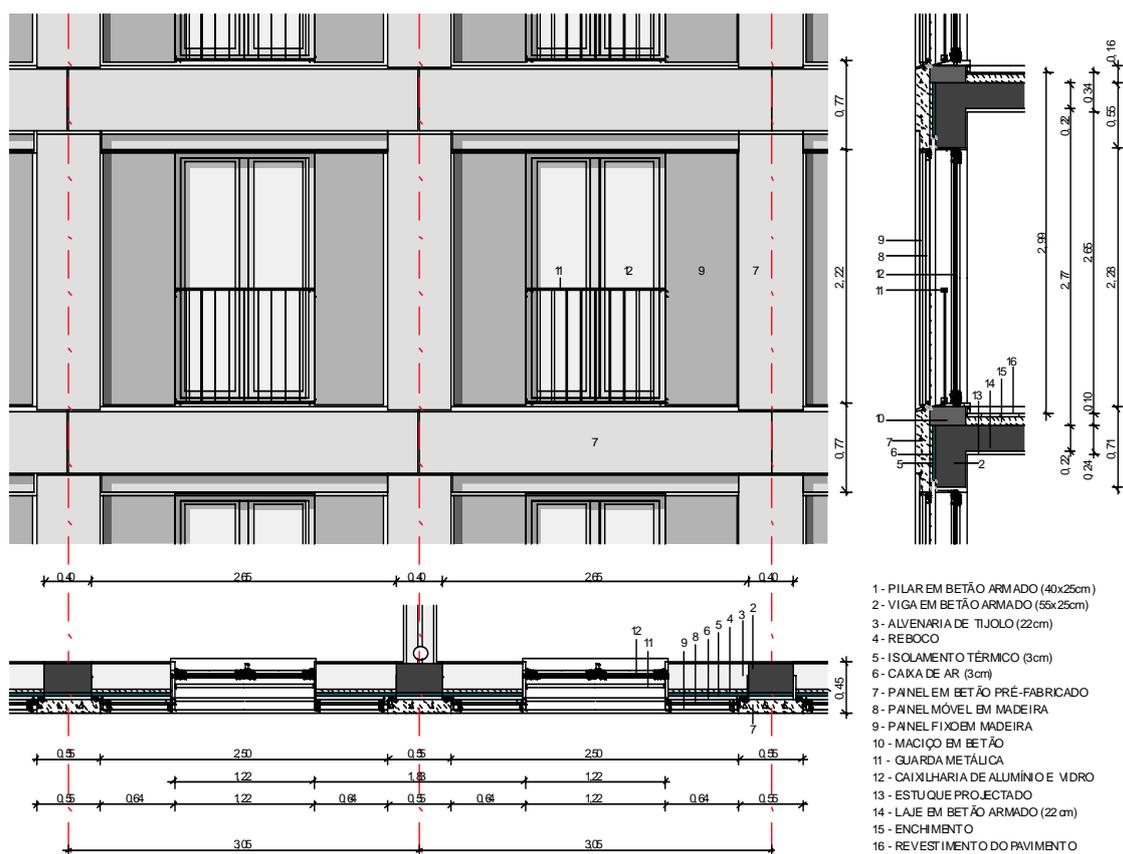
Modulações definidas para elementos da estrutura e da fachada [Fonte: adaptado das bases digitais do projecto de execução]
